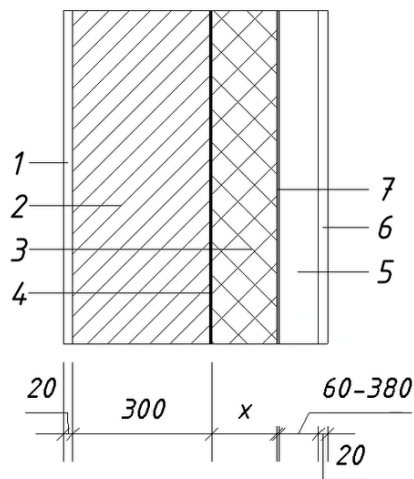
Склад огорожувальної конструкції будівлі
